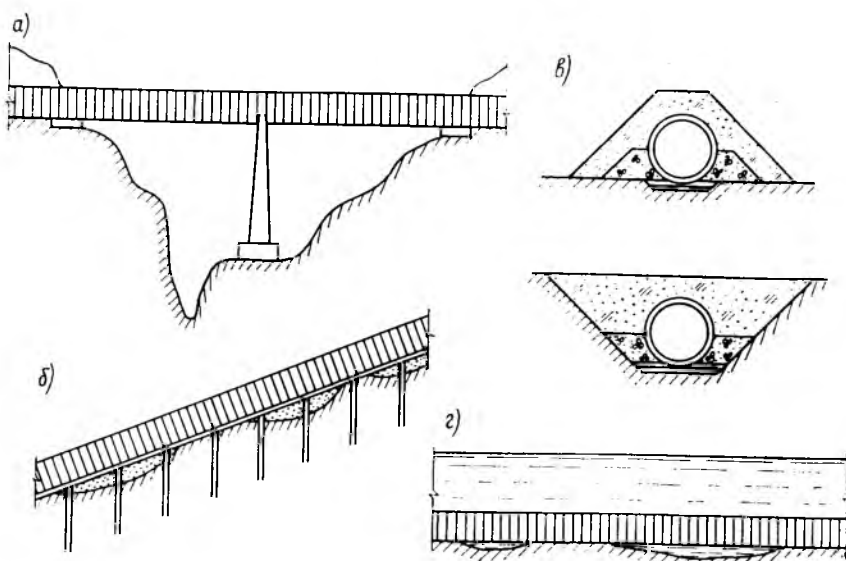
Схемы напорных самонапряженных трубопроводов а — на столбах; б — на свайном ростверке; в — под насыпью или землей; г — на дне моря
